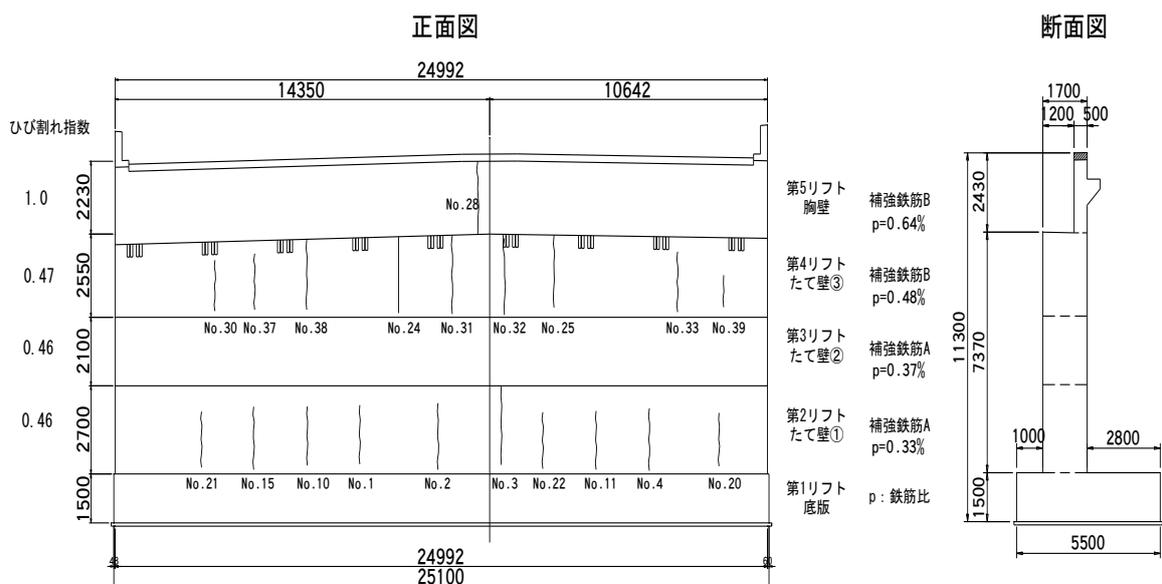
補強鉄筋を配置してひび割れを分散させた幅25mの橋台 (図左端の数字はリフト毎のひび割れ指数を示す。たて壁①とたて壁③では0.06mm以下のひび割れが10本程度確認され、たて壁②ではひび割れは確認されなかった。)
